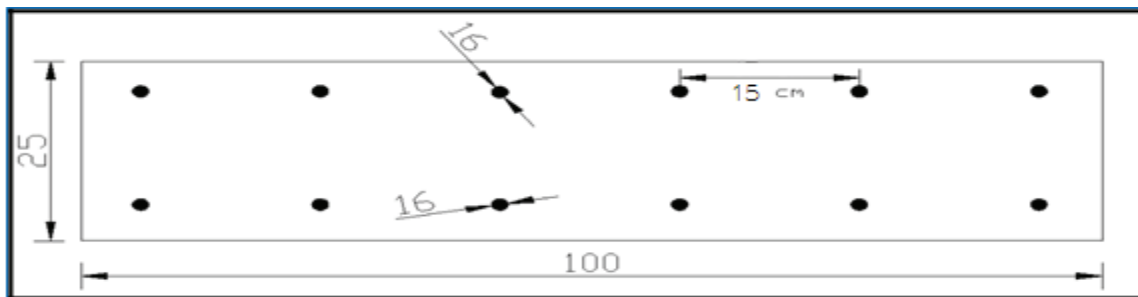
Schéma de ferrailage transversal de la dalle
